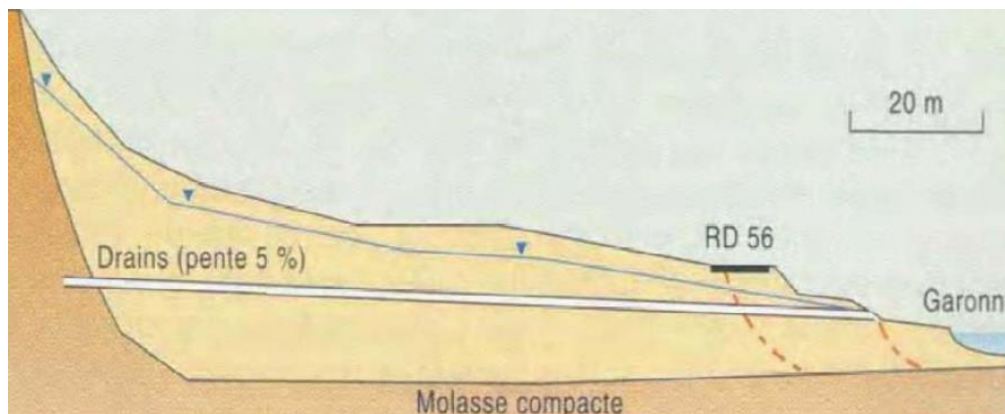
Stabilisation par drains subhorizontaux de la RD à Muret (Haute-Garonne, France).
